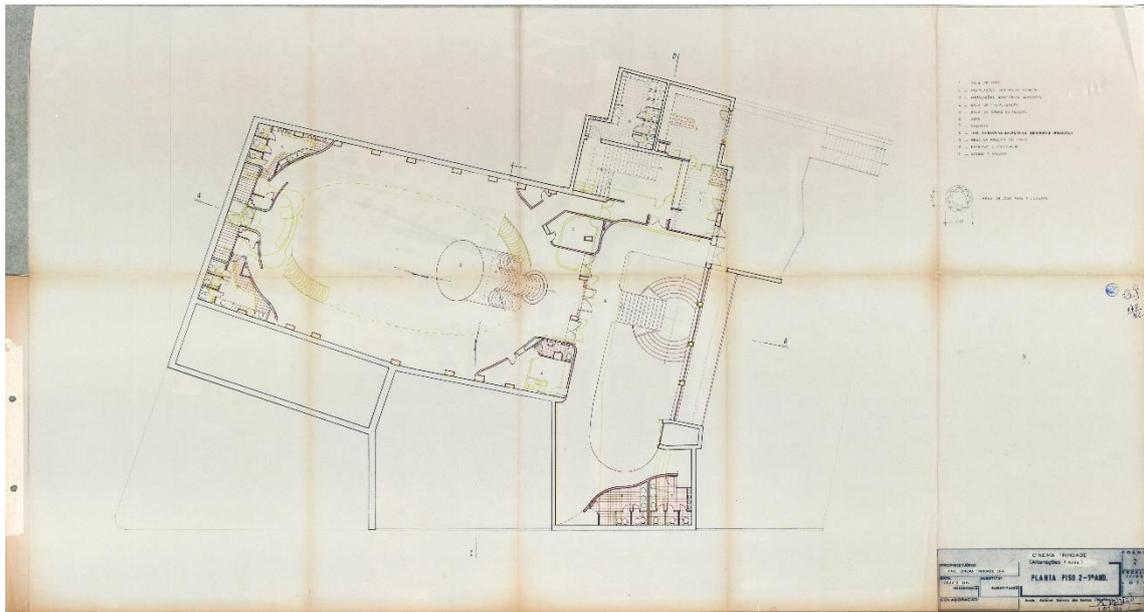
Planta superior sobre a sala de jogo, instalações sanitárias, sala de fiscalização, sala do chefe do pessoal, copa, cozinha, instalações sanitárias, acessos e mesa da máquina do bingo
